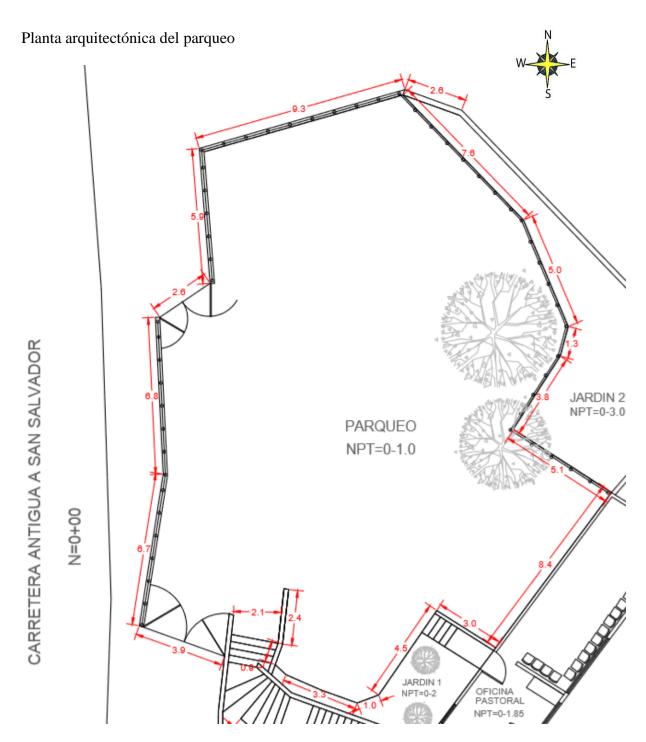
Planta arquitectónica del parqueo. Elaboración propia.
